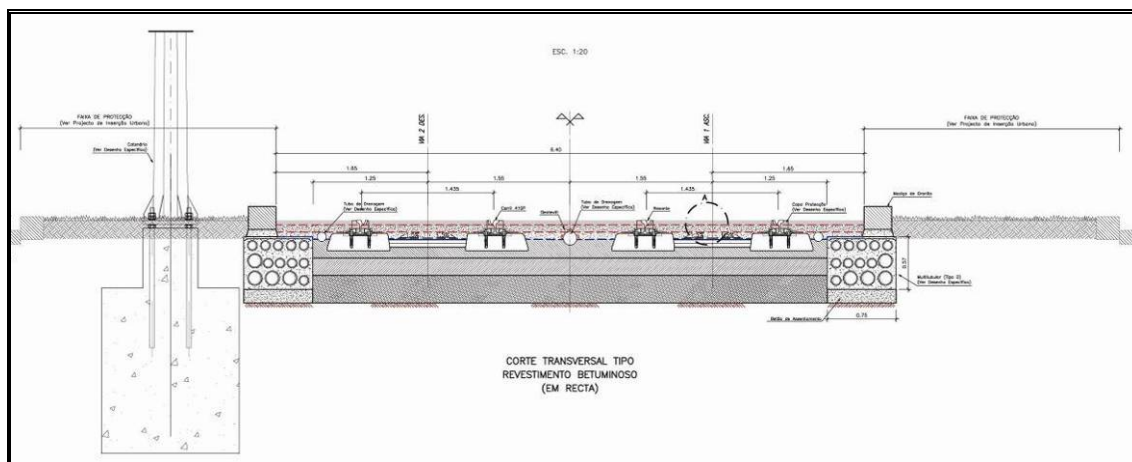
Corte Transversal Tipo Revestimento Betuminoso
